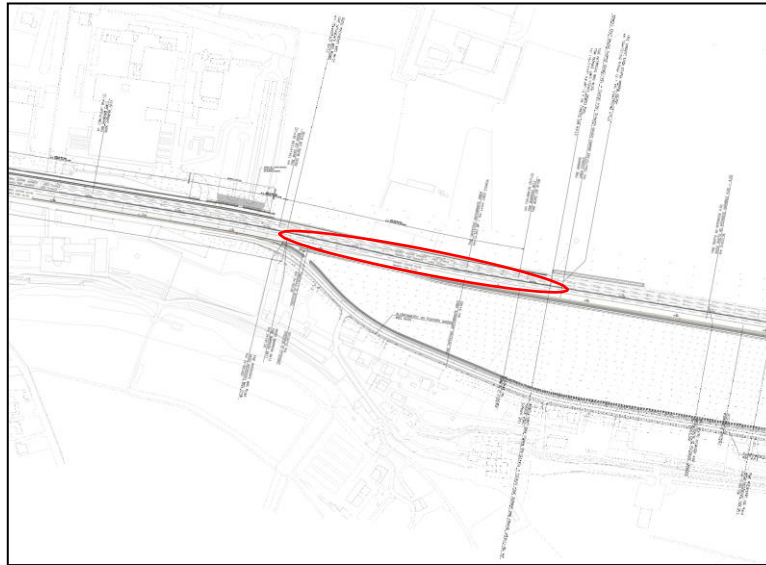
Planimetria di progetto, in rosso l'area oggetto di modifica
